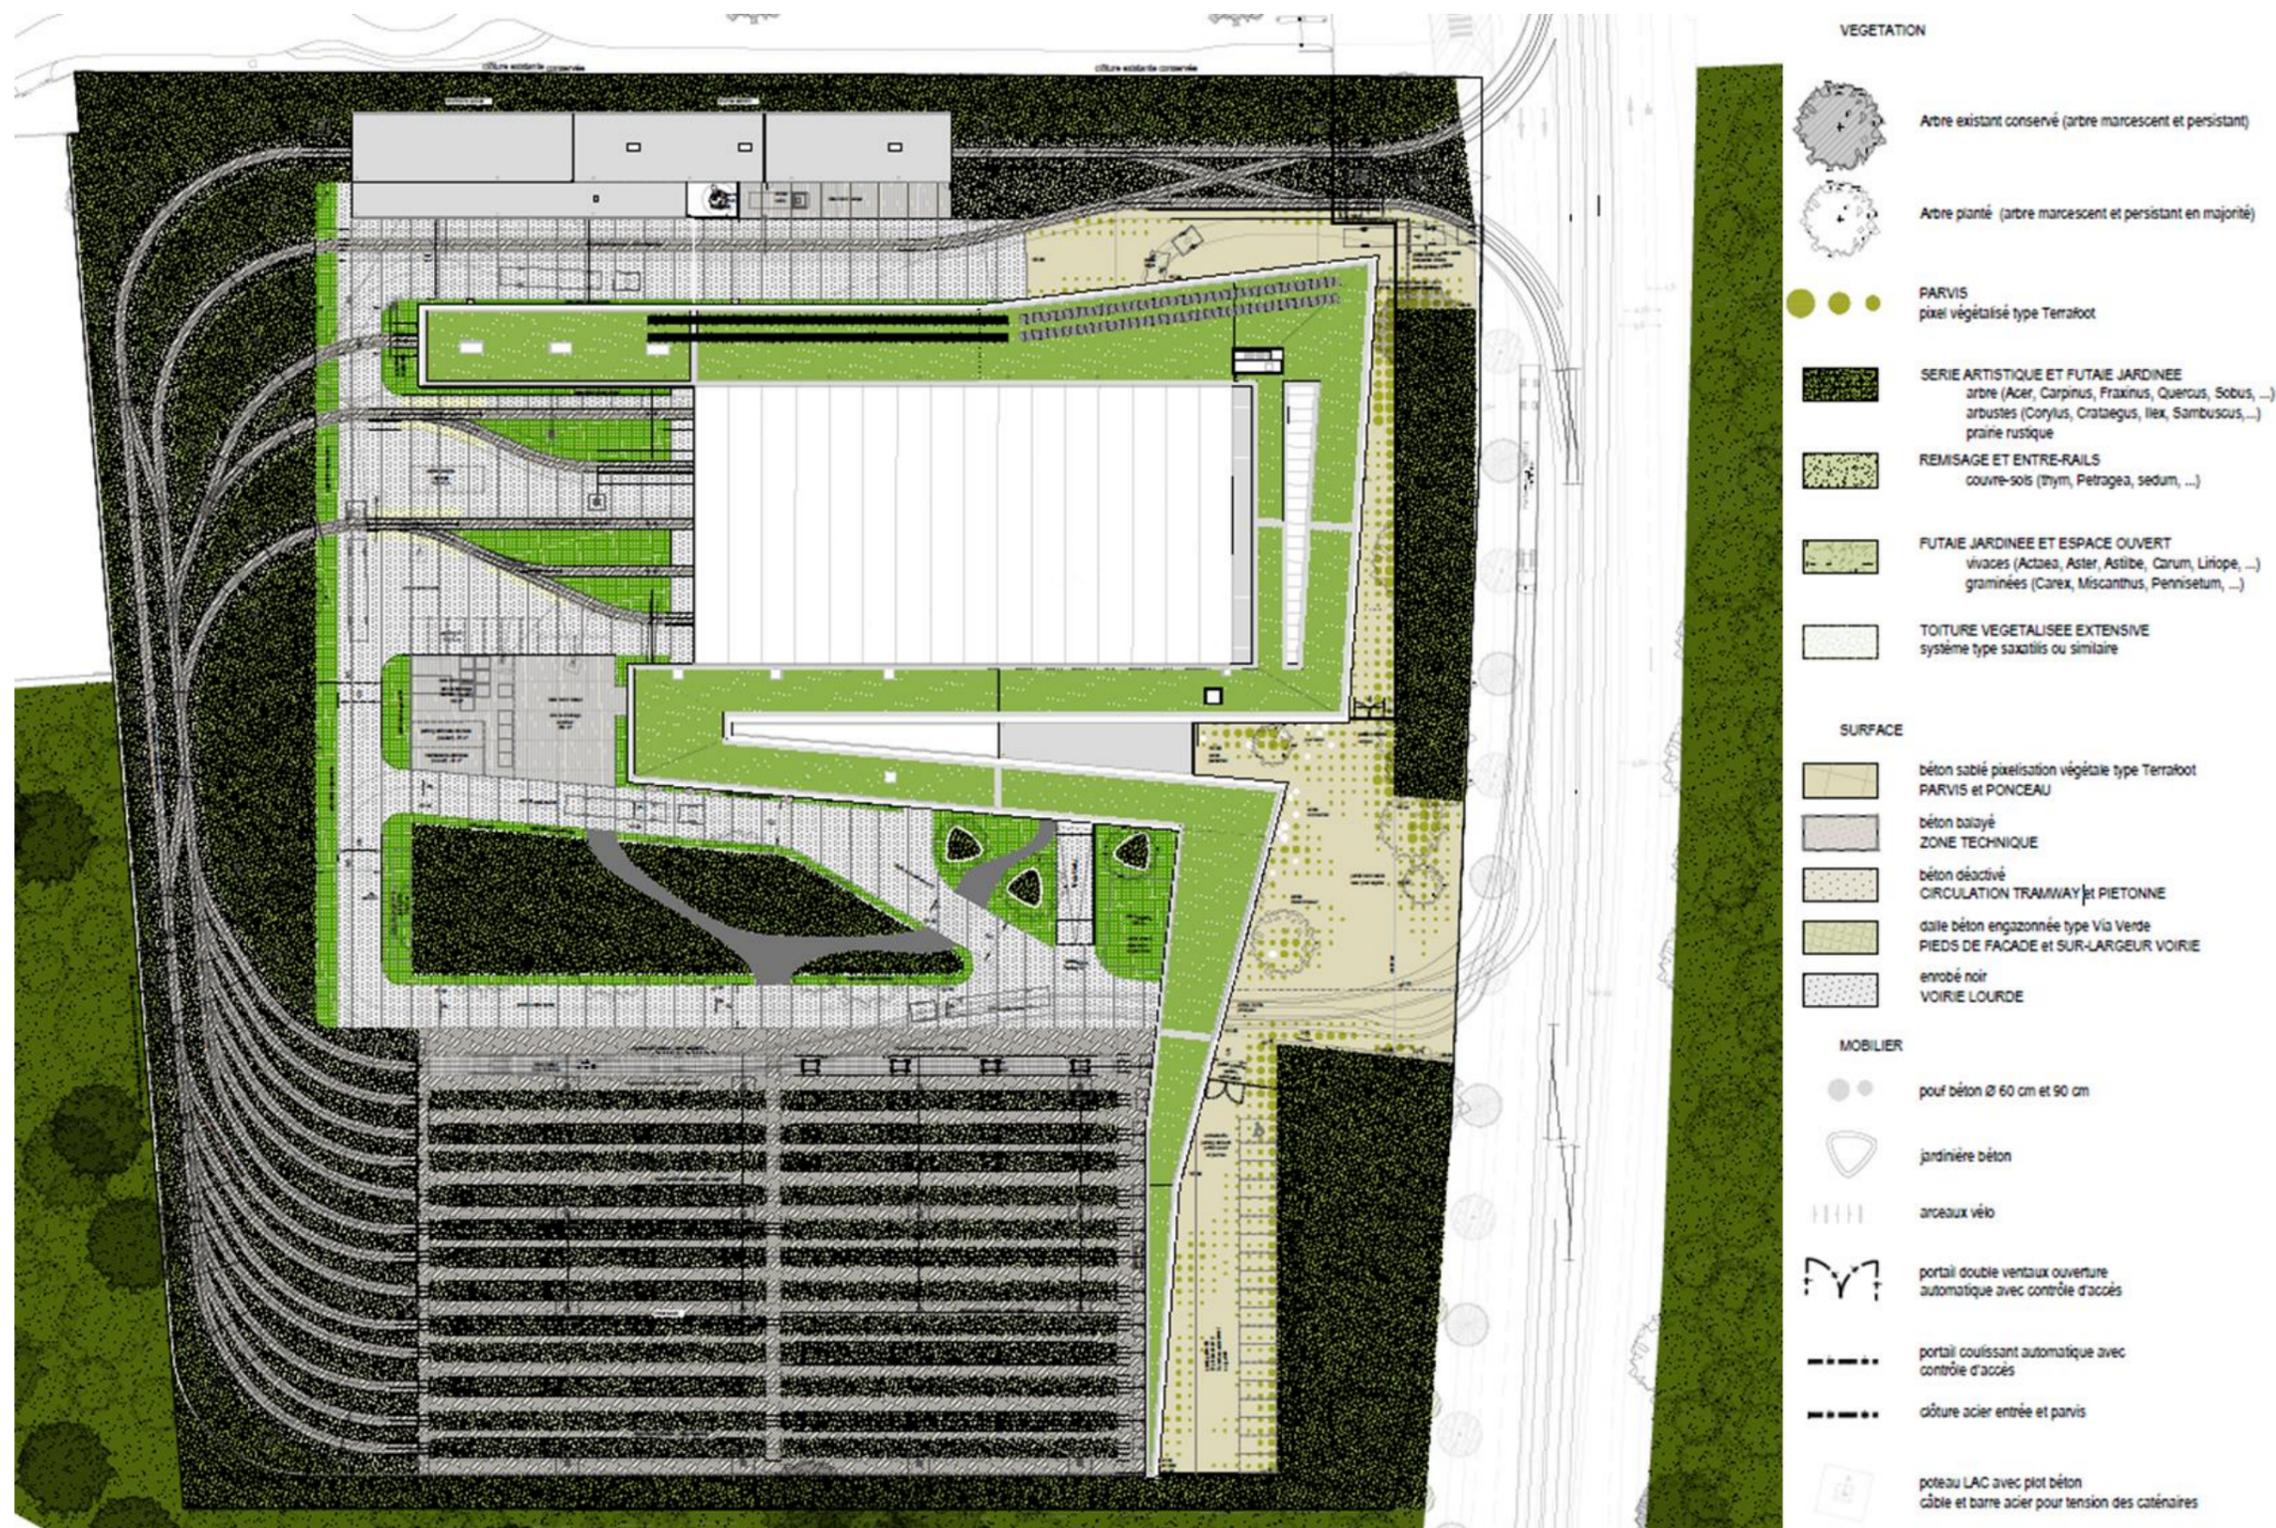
Vue Plan d'implantation du SMR – Représentation avec la dalle et vue du faisceau de remisage – Site sans dalle – Études APD, source : AIA
